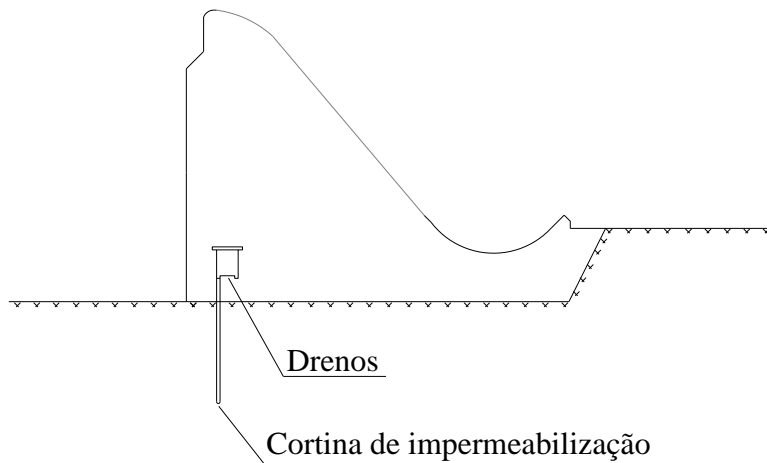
Cortina de impermeabilização e rede de drenagem
